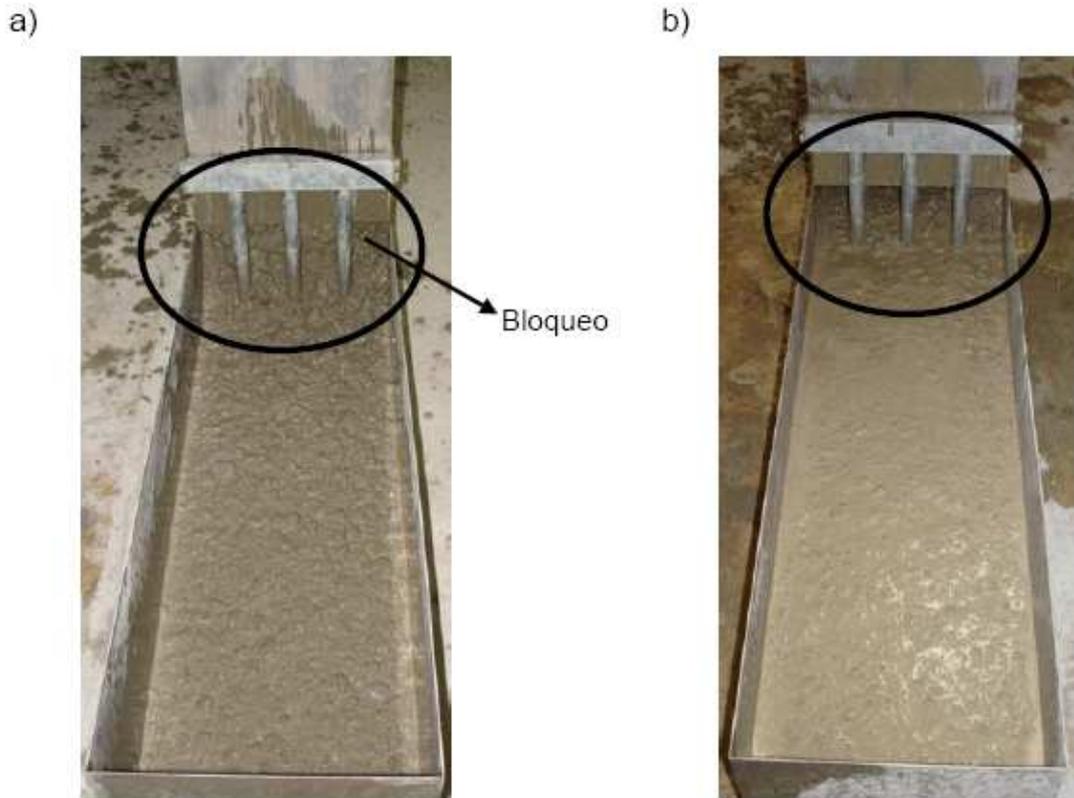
Ensayo Caja L. (E. Bermejo) [11]
